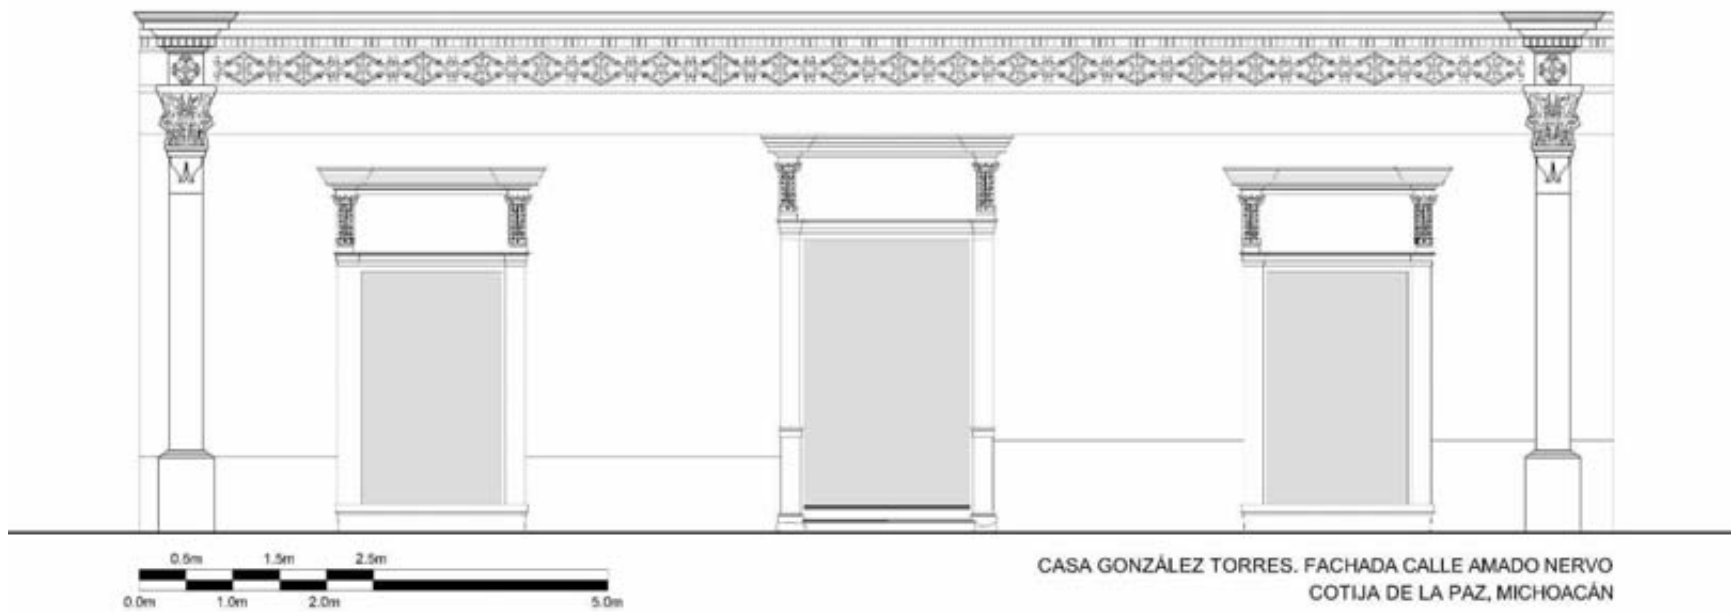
Fachada de la Casa González Torres con los aplanados en la fachada.
